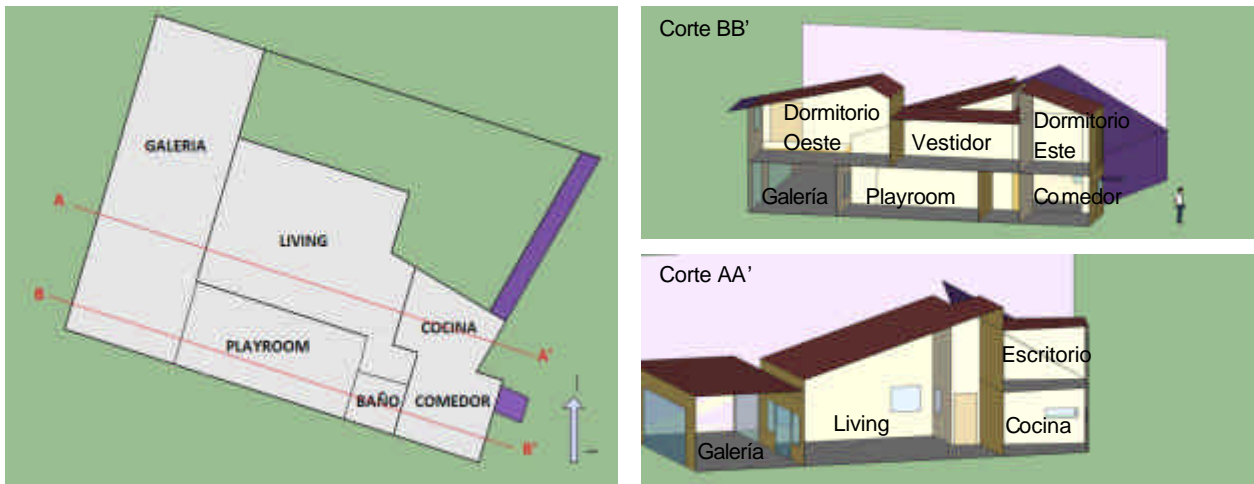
Planta y cortes AA' y BB' de la vivienda.
